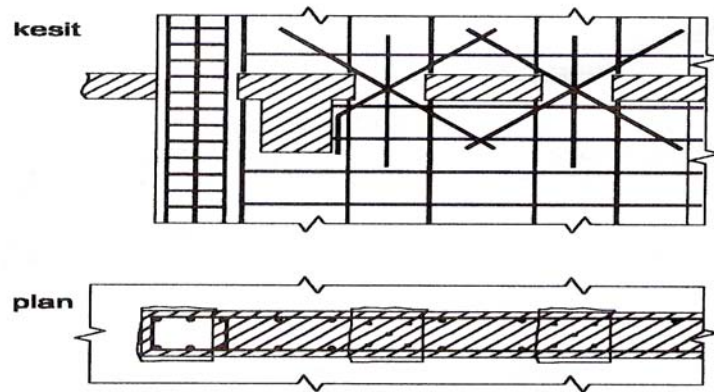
Dış perdenin mevcut temele bağlanması
